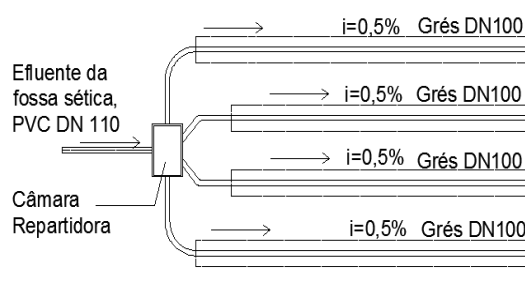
Planta de uma solução de trincheiras de infiltração (adaptada de Morais, 1977).
